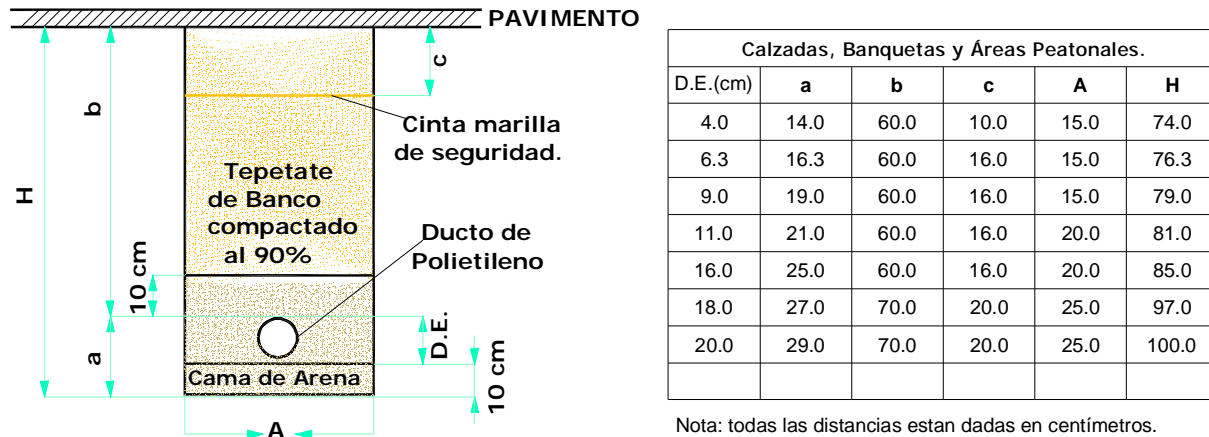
Excavación de la zanja para las tuberías de gas natural. (Cortesía de GNM^[H]).
